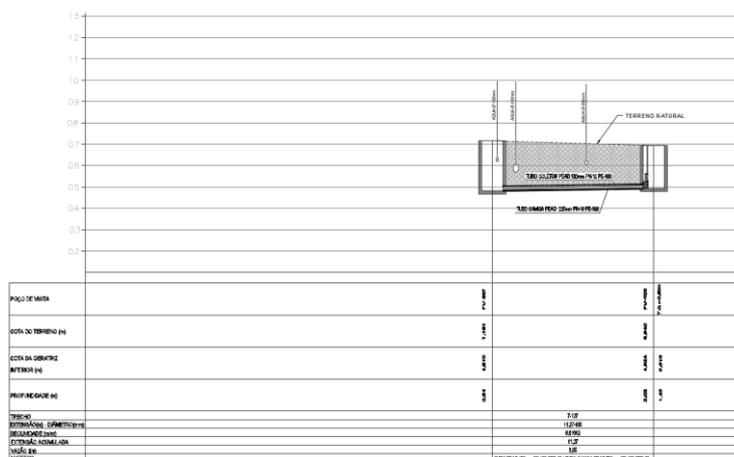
Perfil longitudinal da travessia SB-T22 PV-326 AO PV-337
